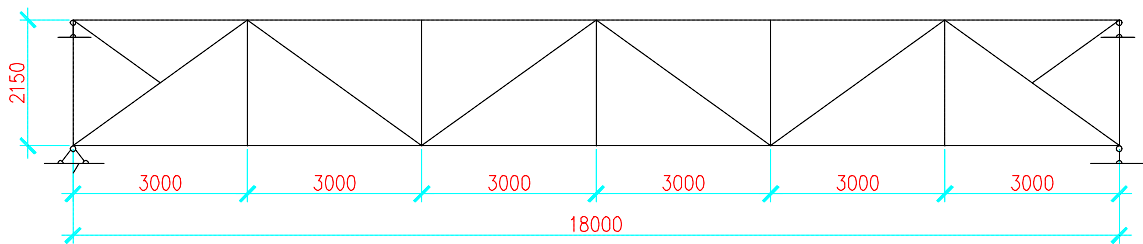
Расчетная схема стропильной фермы _ вариант 1
